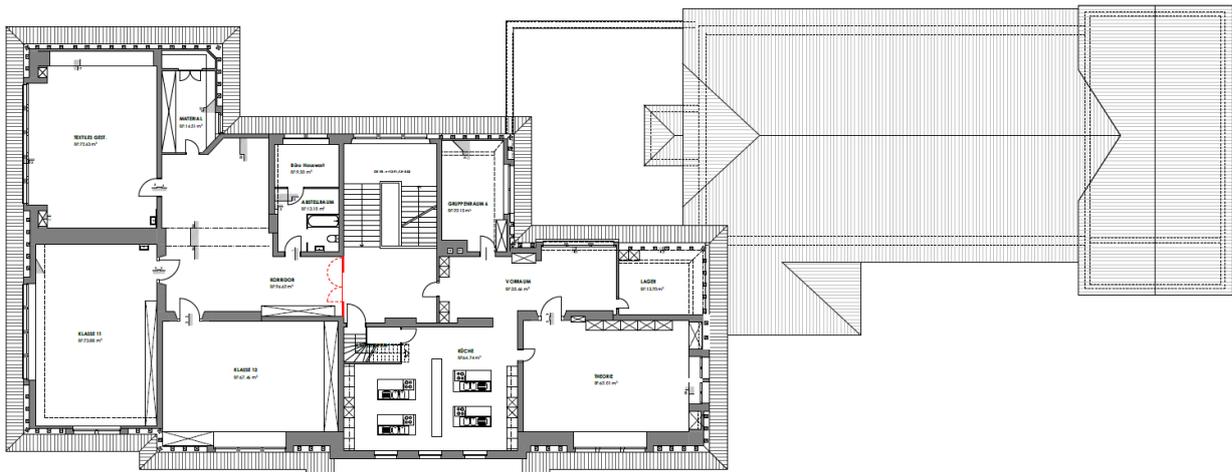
; Grundriss Dachgeschoss Haupttrakt (1. Teilsanierung)
